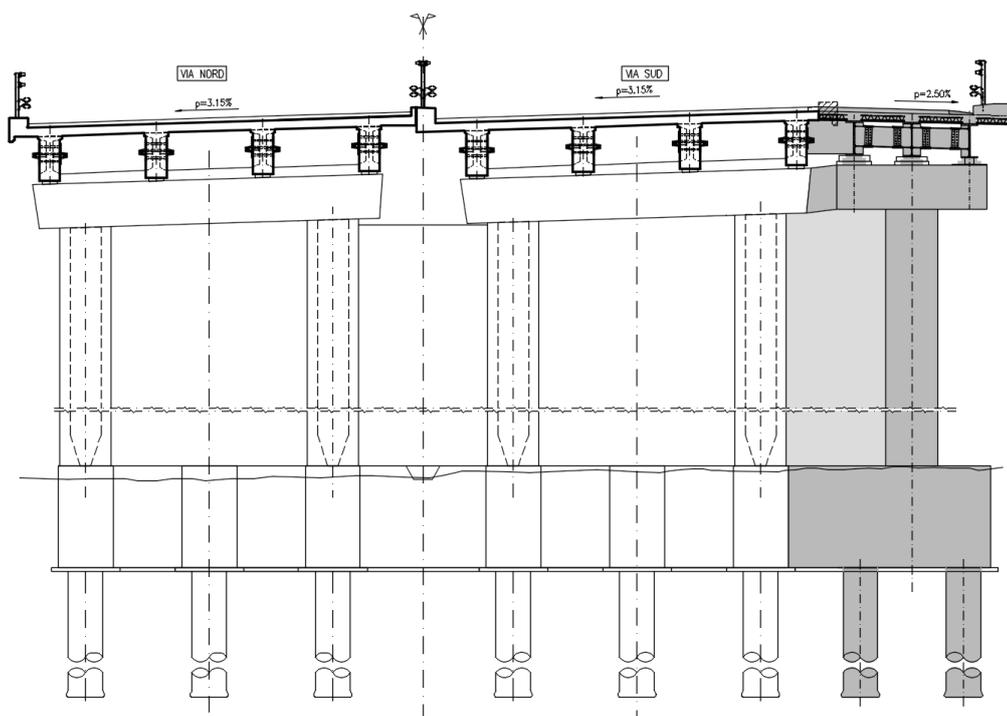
Sezione trasversale di progetto delle pile del viadotto Zuane
